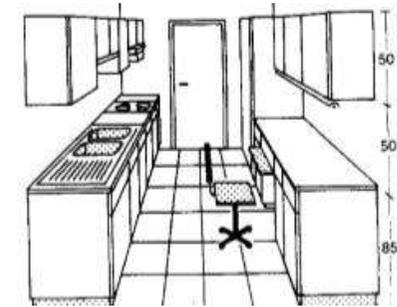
Ruang Dapur Restoran Pengunjung 60-100
